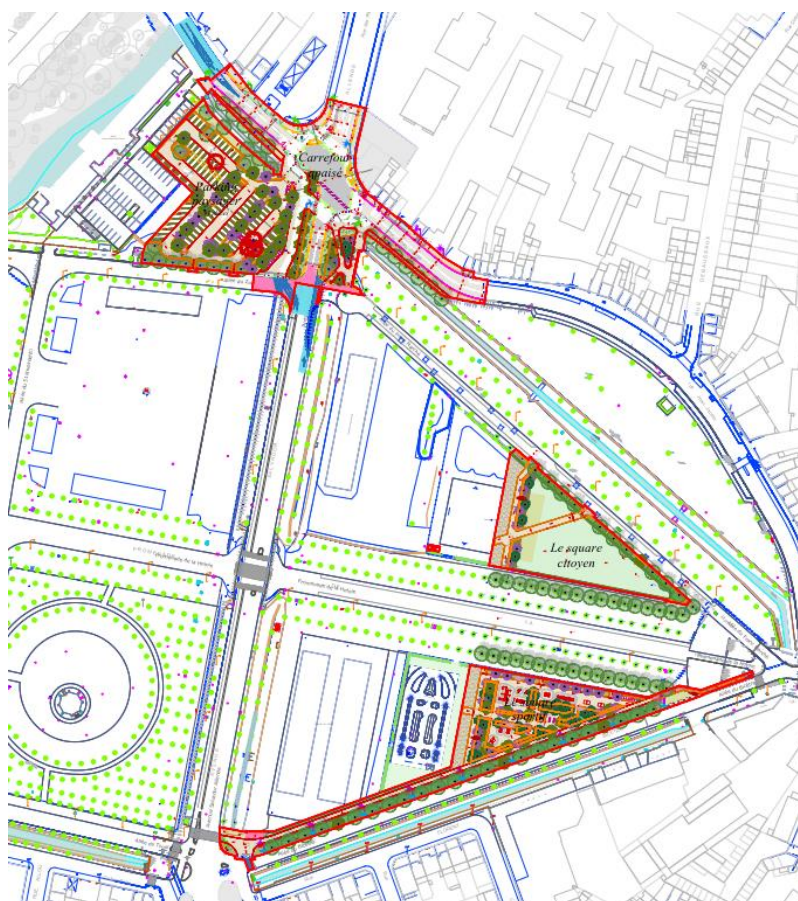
Plan Masse du projet d'aménagement du parc de la Hotoie (source : BASE – AVP – Plan masse général - mars 2024)
